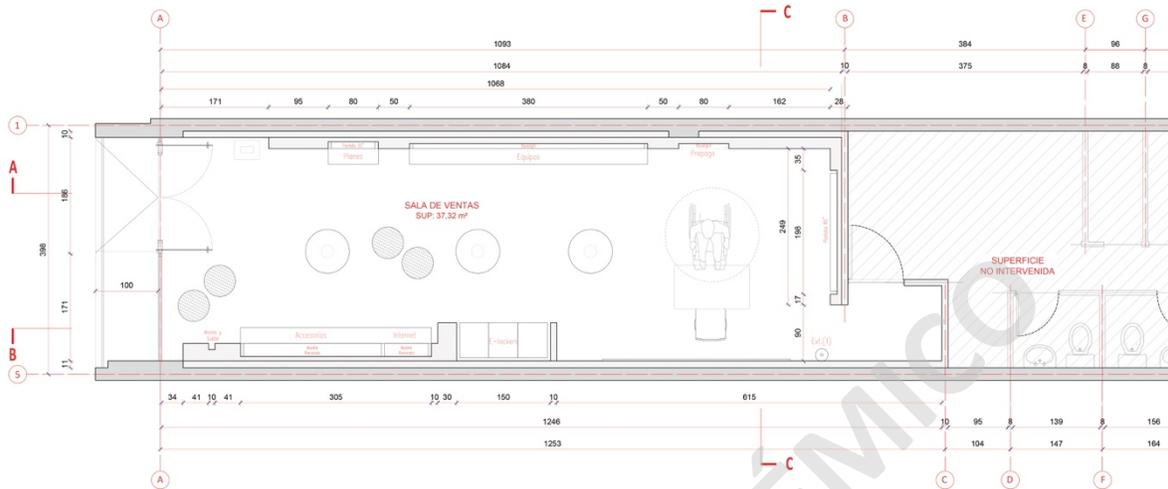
Sucursal Apumanque - Planta Arquitectura.
